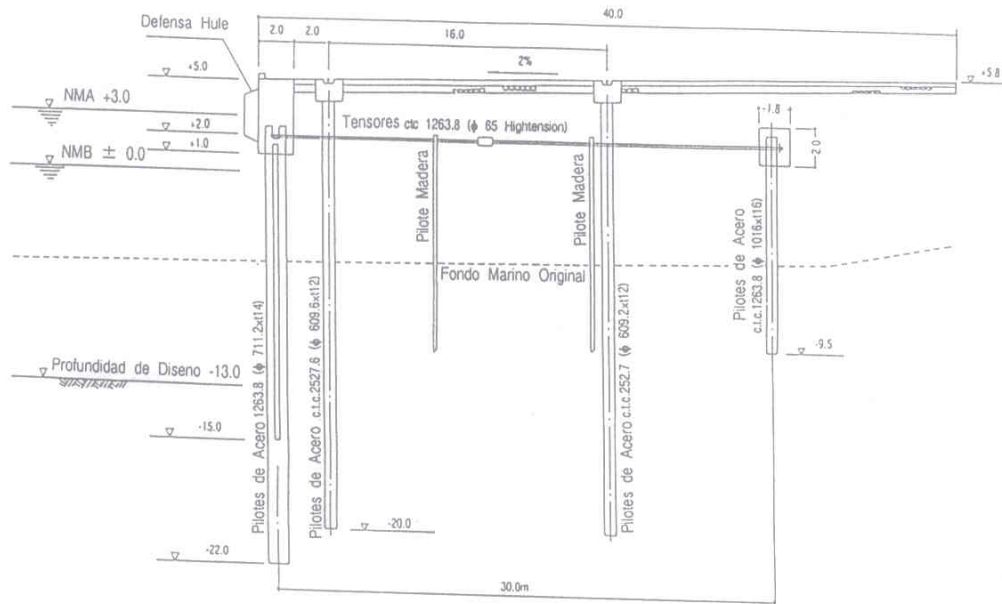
Sección Típica del Atracadero para Atuneros
